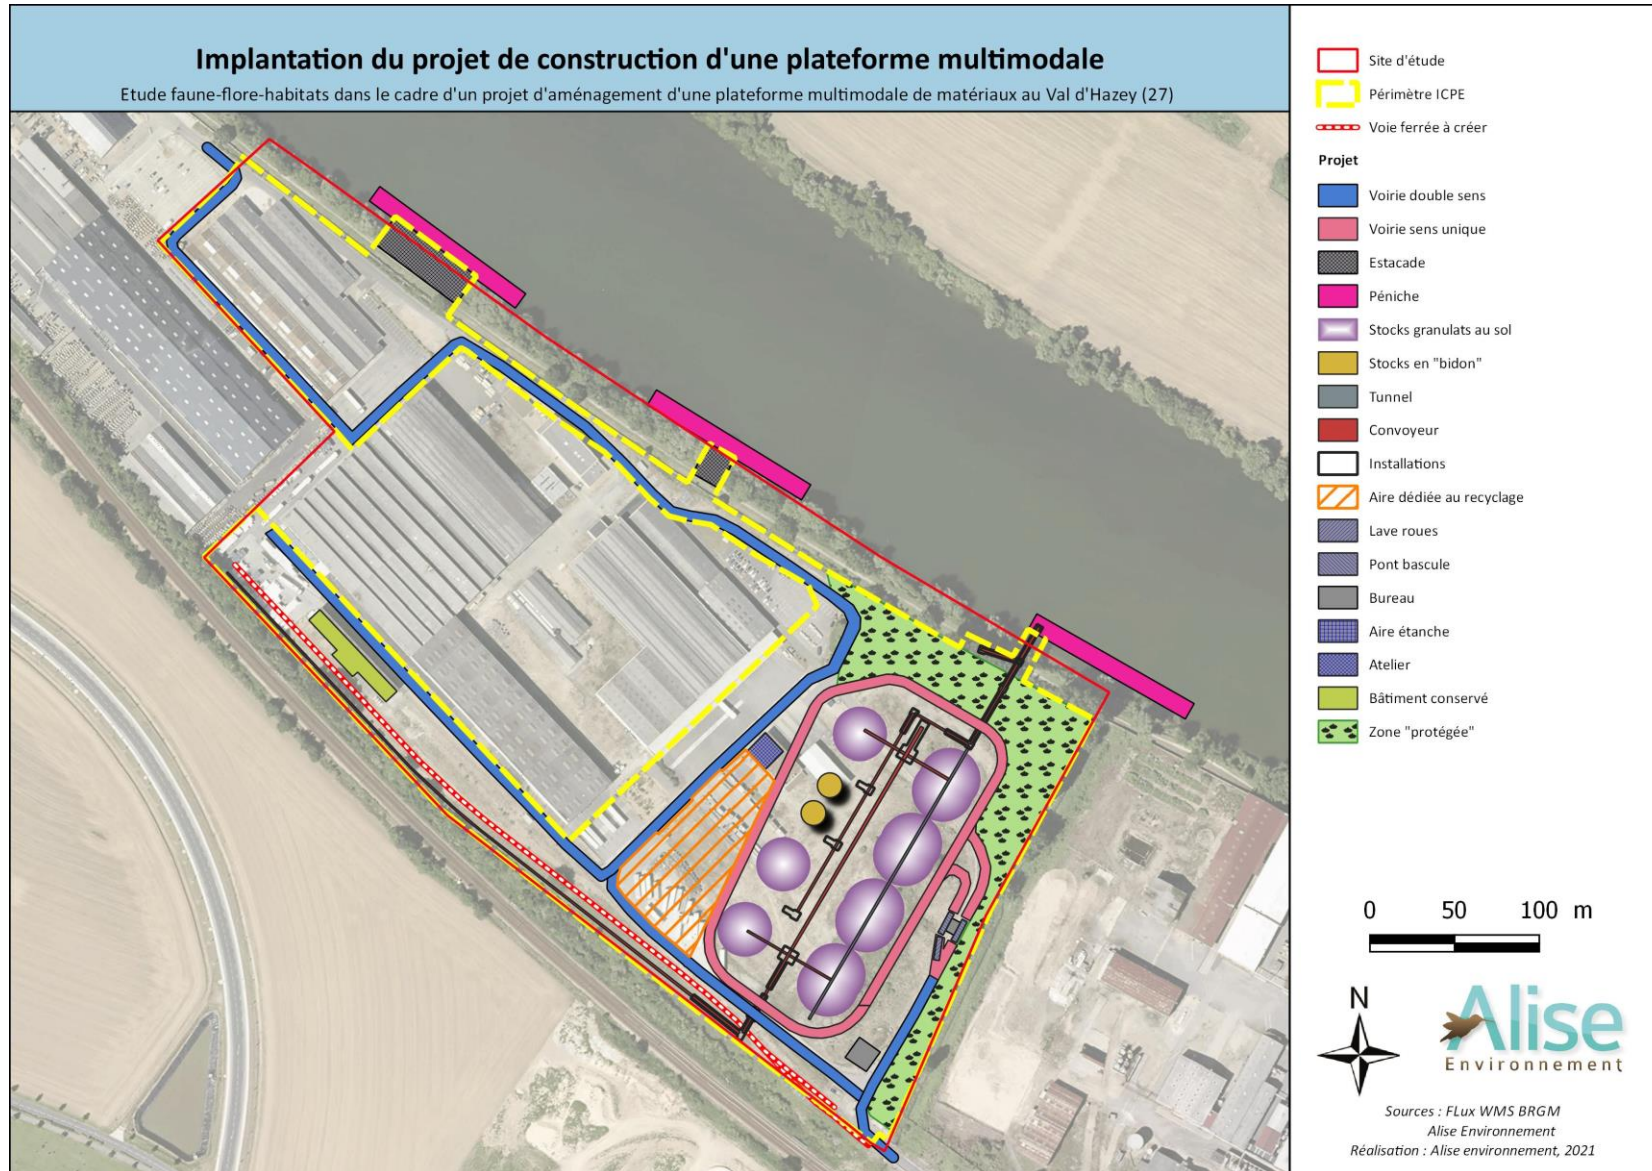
Implantation du projet de construction d'une plateforme multimodale
